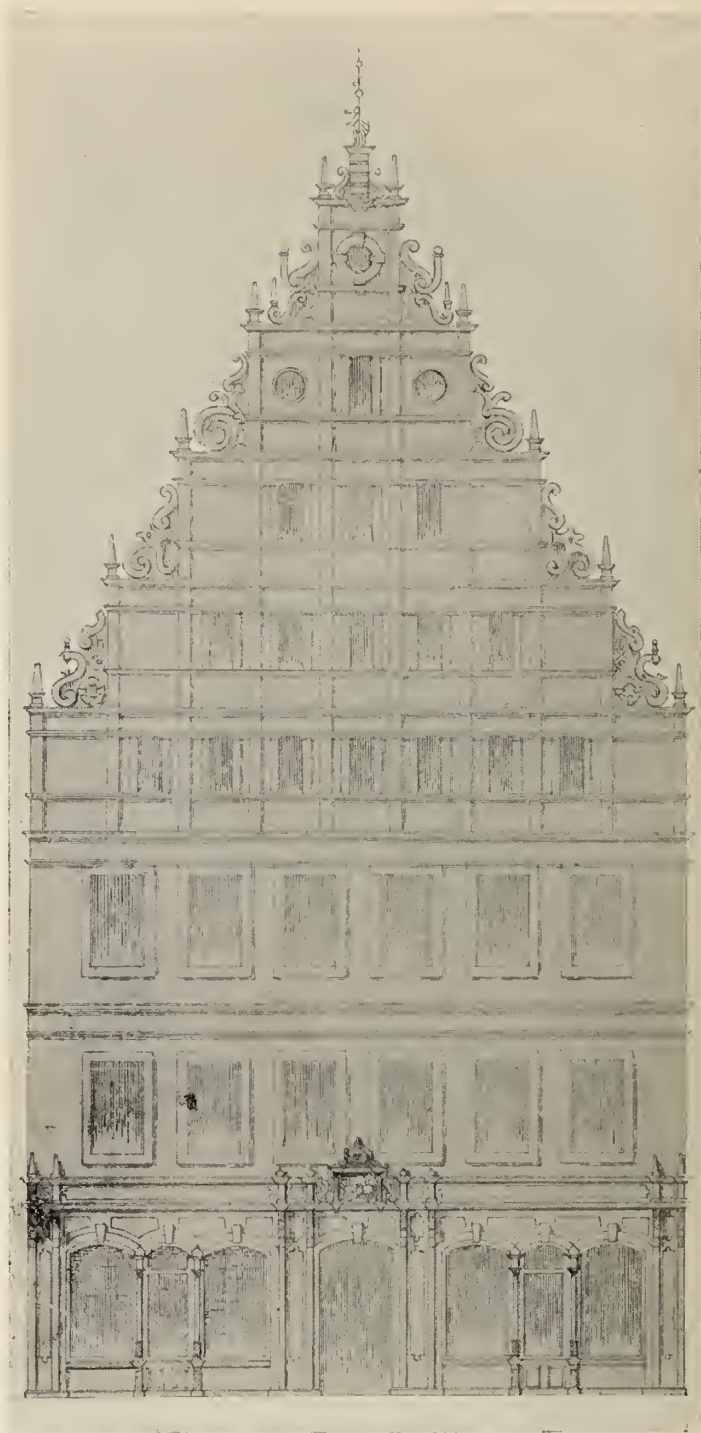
Hannover; Marktstraße 49. Fassadenaufnahme 1860. Stadtarch.
